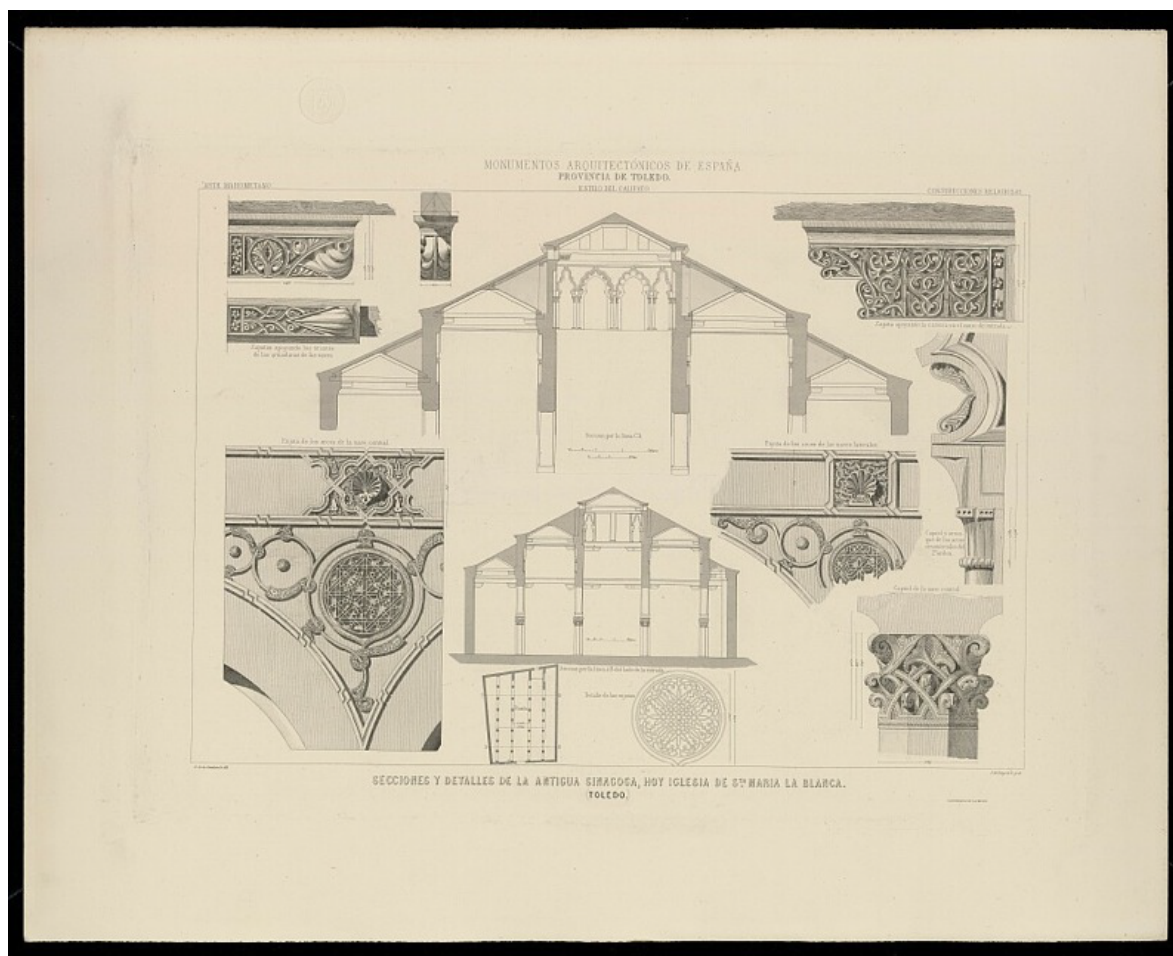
Übersicht Grundriss und Aufriss, Santa María la Blanca, Toledo.
